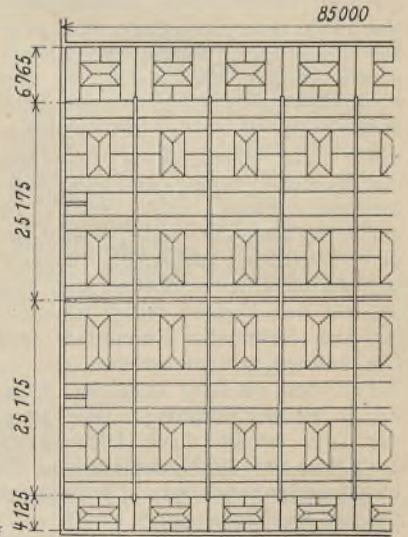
Teilgrundriß der Dachkonstruktion.
